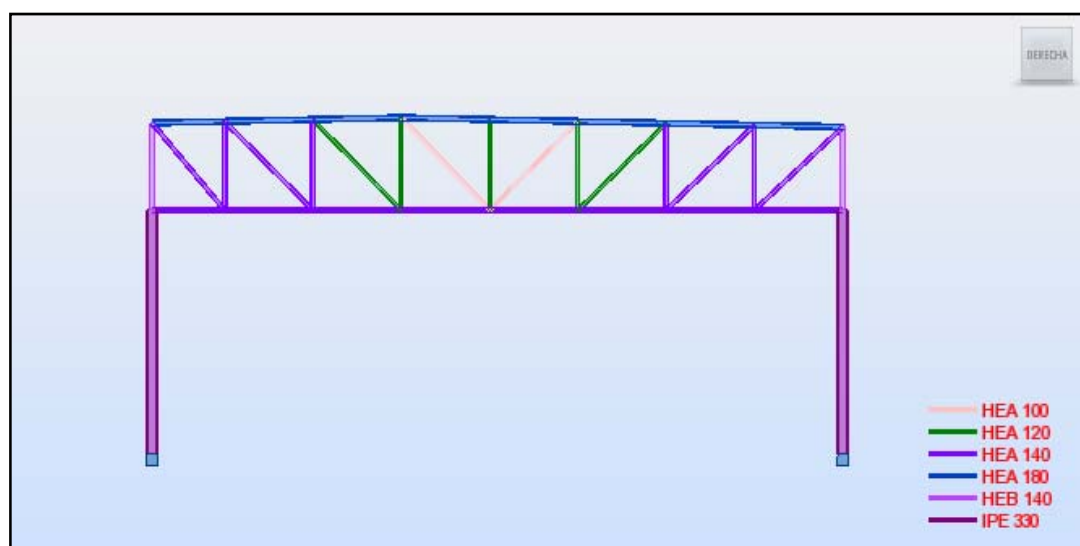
Alzado de celosía 2 o Exterior (Modelo estructural del proyecto)
